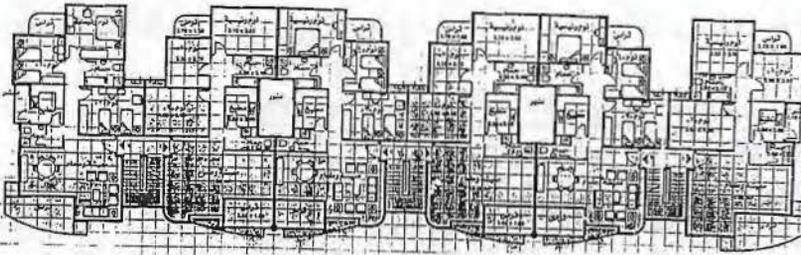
مسقط أفقي للطور الأرضي - المرحلة الرابعة عمارات (نموذج ٣)
